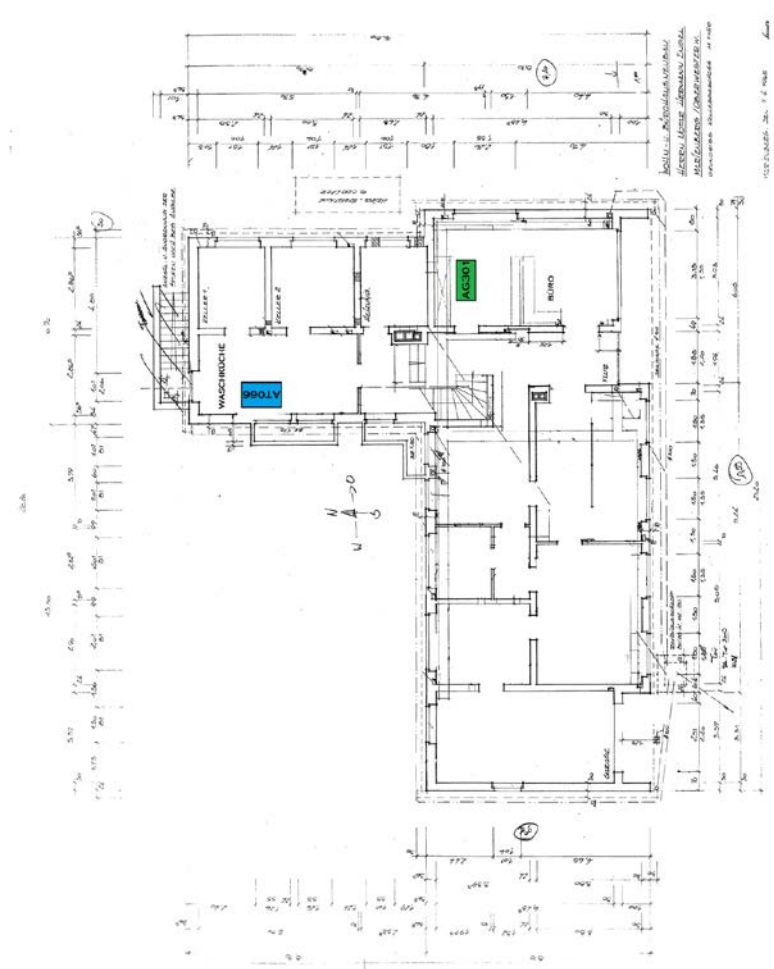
Grundriss des Untergeschosses/Souterrain
